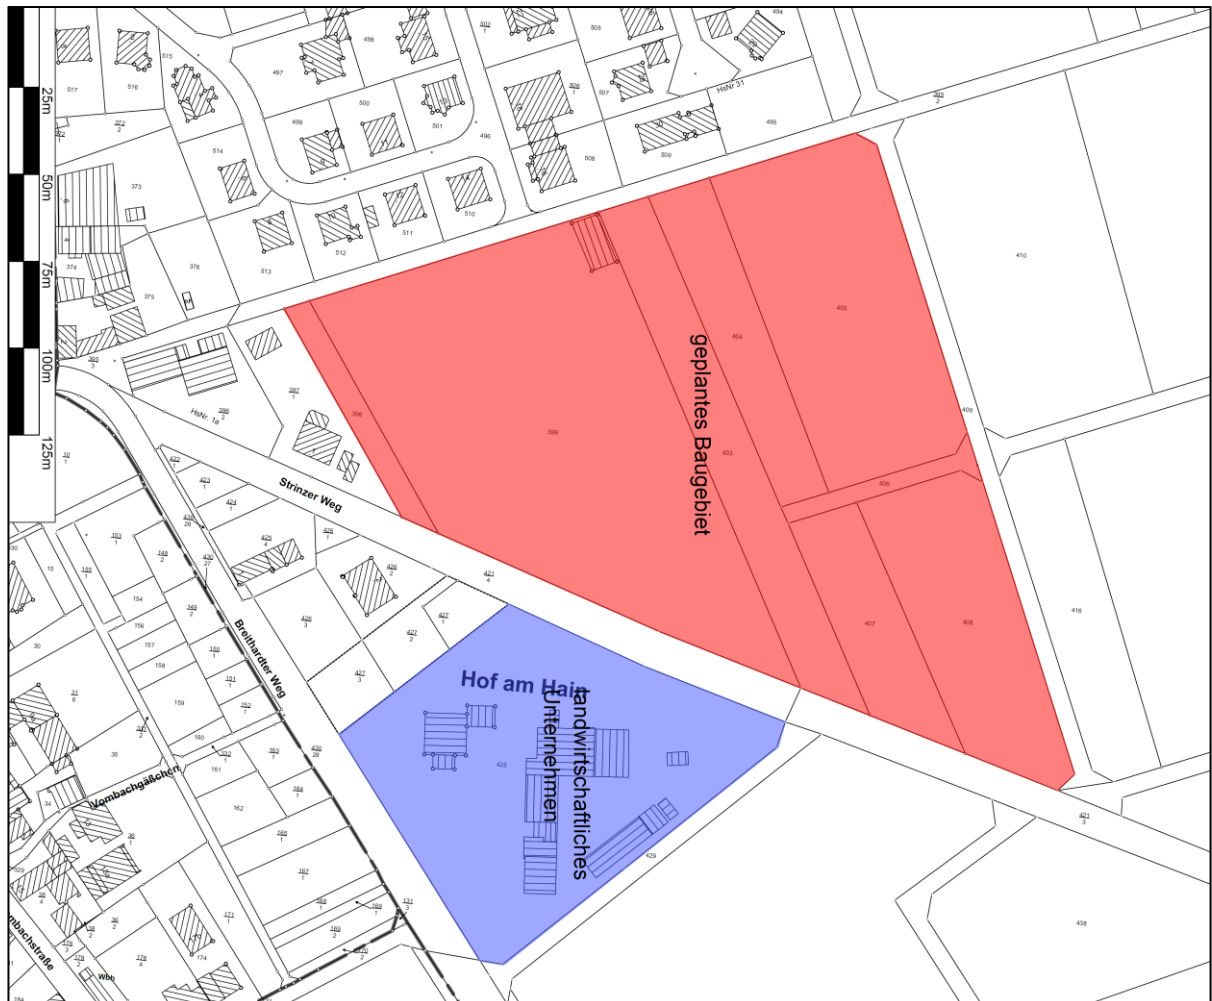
Lageplan des Plangebietes (Quelle: Bauamt Gemeinde Hohenstein, Stand 04.03.2022)
